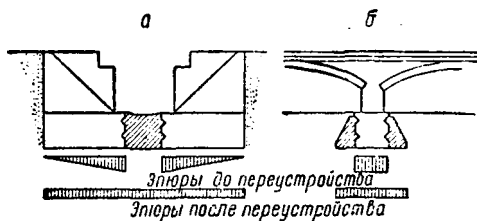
Улучшение условий работы основания при помощи перемещения опорной площадки к середине устоя
